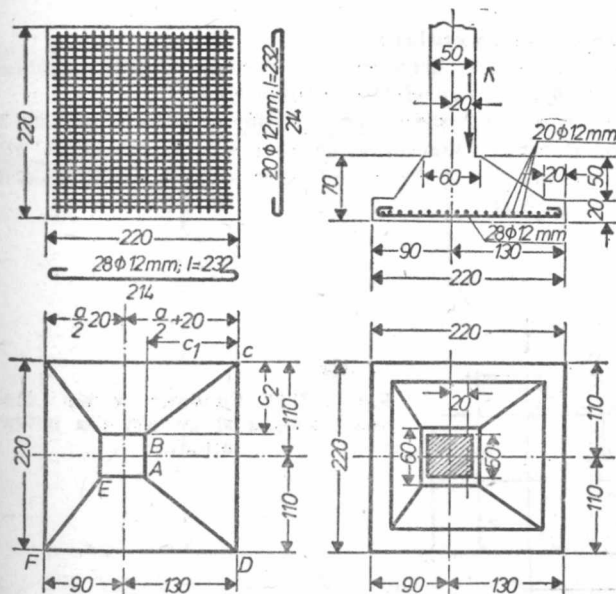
Fundație din beton armat, solicitată excentric.
